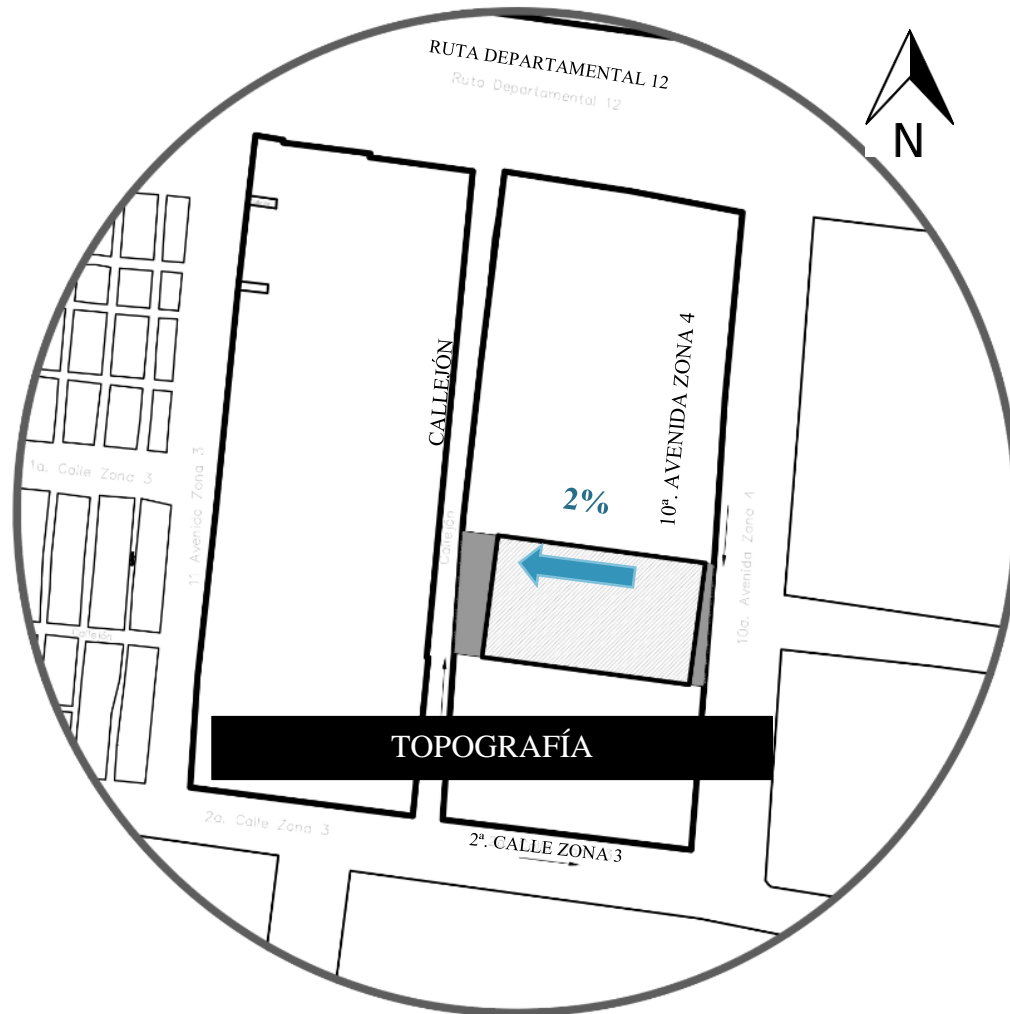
PLANTA DE TOPOGRAFÍA/ FUENTE/ ELABORACIÓN PROPIA. UBICADO EN ZONA 3, LAS CRUCES, PETÉN.
